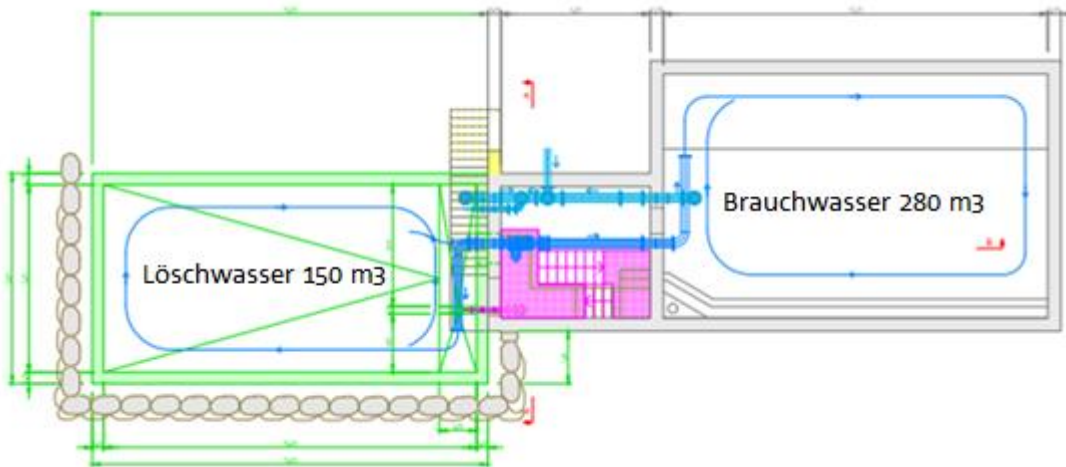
Grundriss Reservoir Sitli (Neubau in grün)
